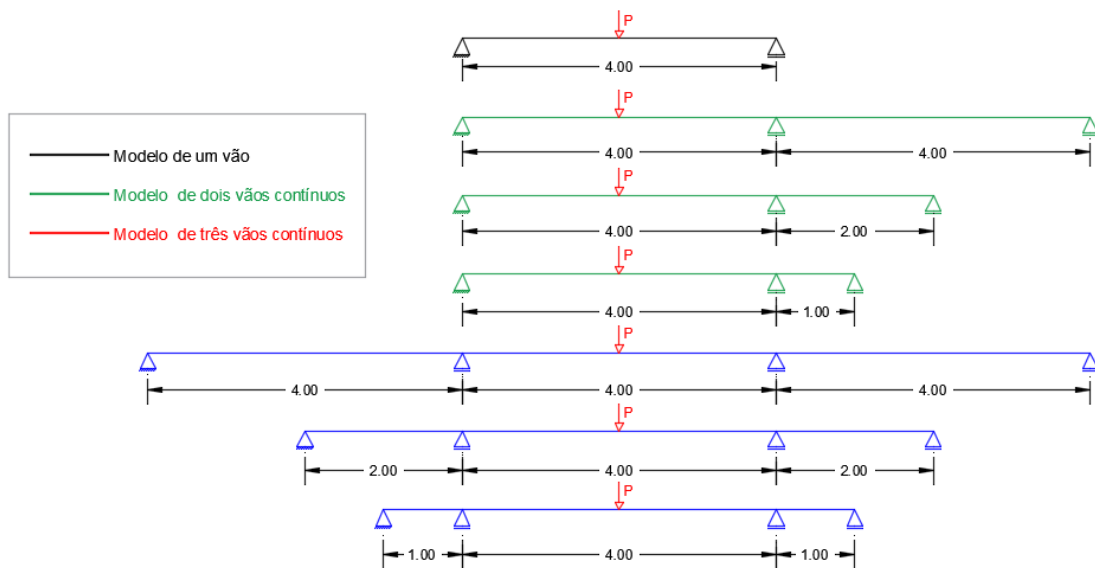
Esquema estrutural das vigas do conjunto de modelos
